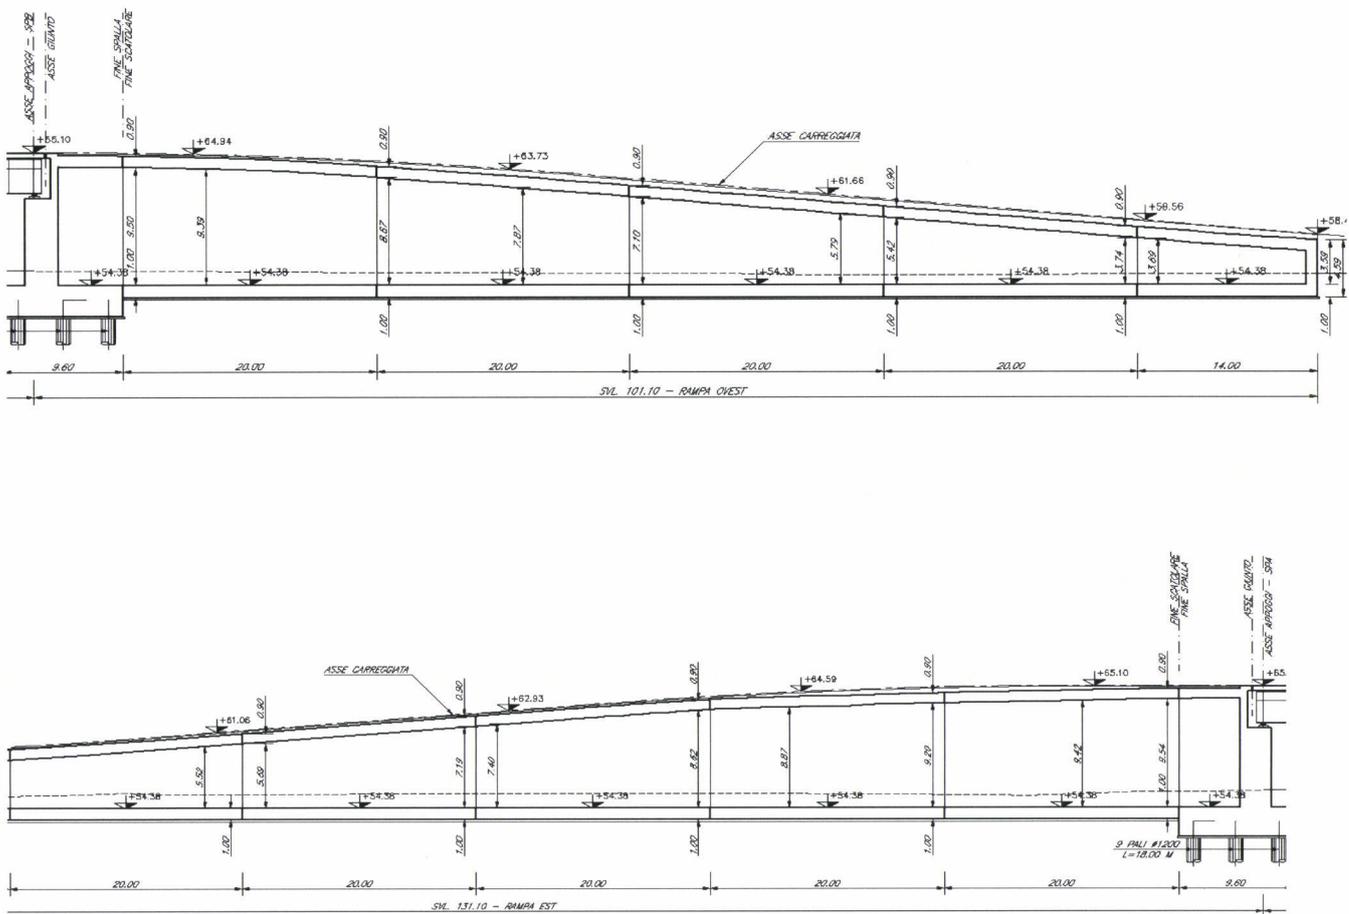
Rampe Est e Ovest di approccio alla campata di scavalco.
